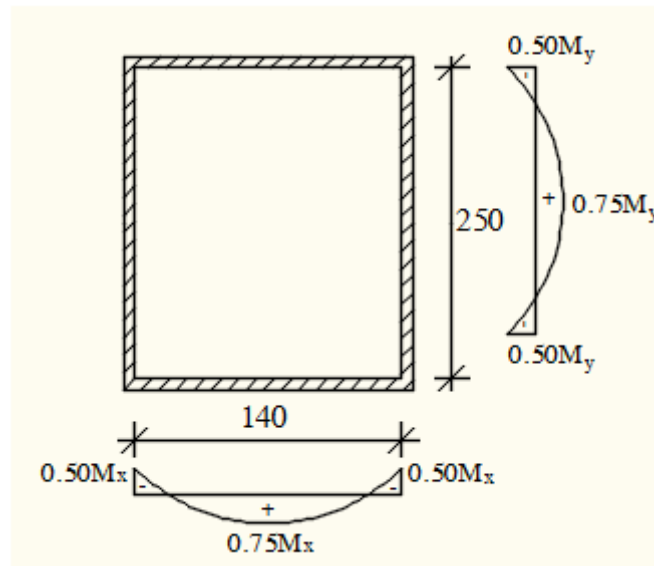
Schéma de panneau de dalle d'ascenseur.
